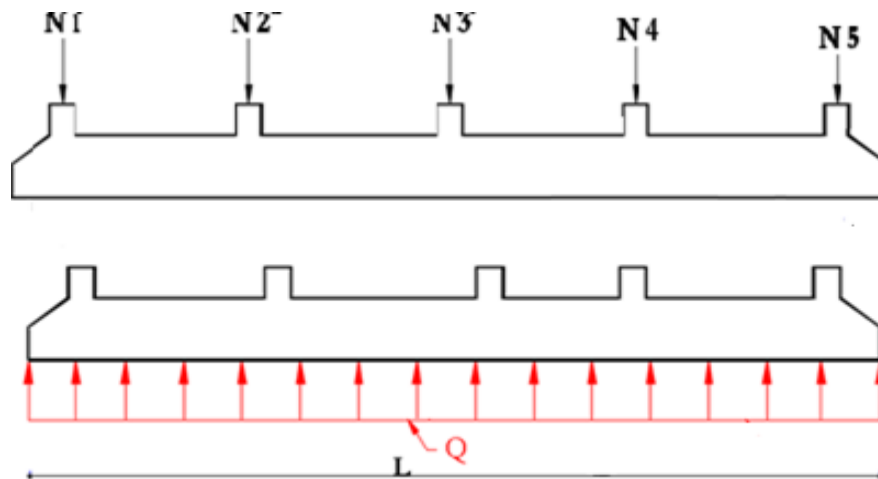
Charges agissantes sur la poutre de rigidité.
